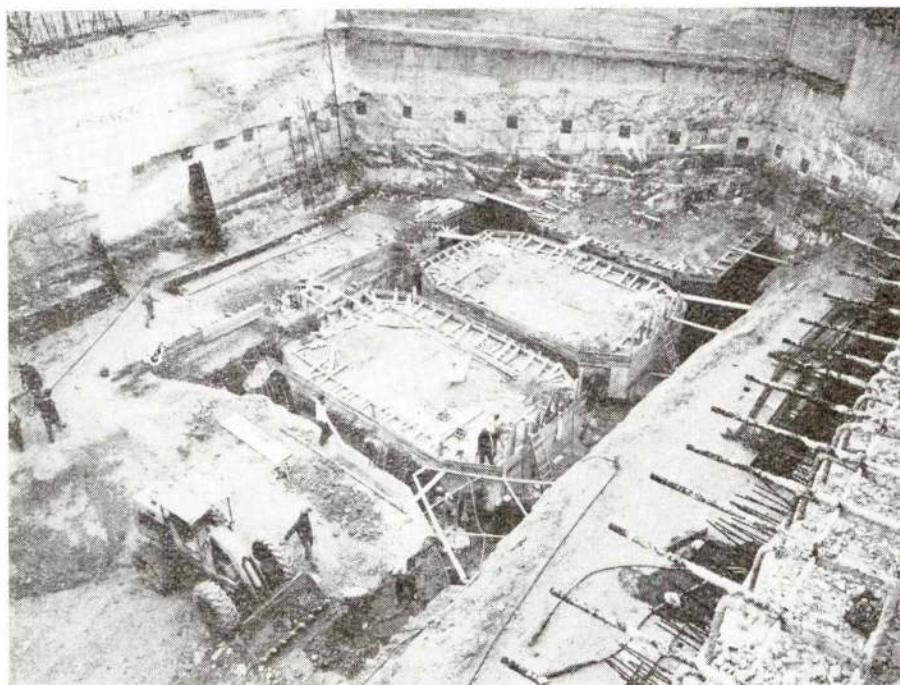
Edifício Europeia da «Companhia de Seguros Europeia» em Lisboa. Panorâmica de parte da parede moldada depois de executada parte da escavação. Podem facilmente observar-se os rectângulos das placas metálicas inseridas na parede quando da betonagem e o apreciável rigor do alinhamento das mesmas. No primeiro plano, à direita pode observar-se o topo da parede moldada com as respectivas armaduras de ligação. Procede-se à escavação para as sapatas e lintéis, podendo observar-se as cabeças das estacas oblongas formadas por elementos de parede moldados. (Doc. Rodio — Foto Silvano).
